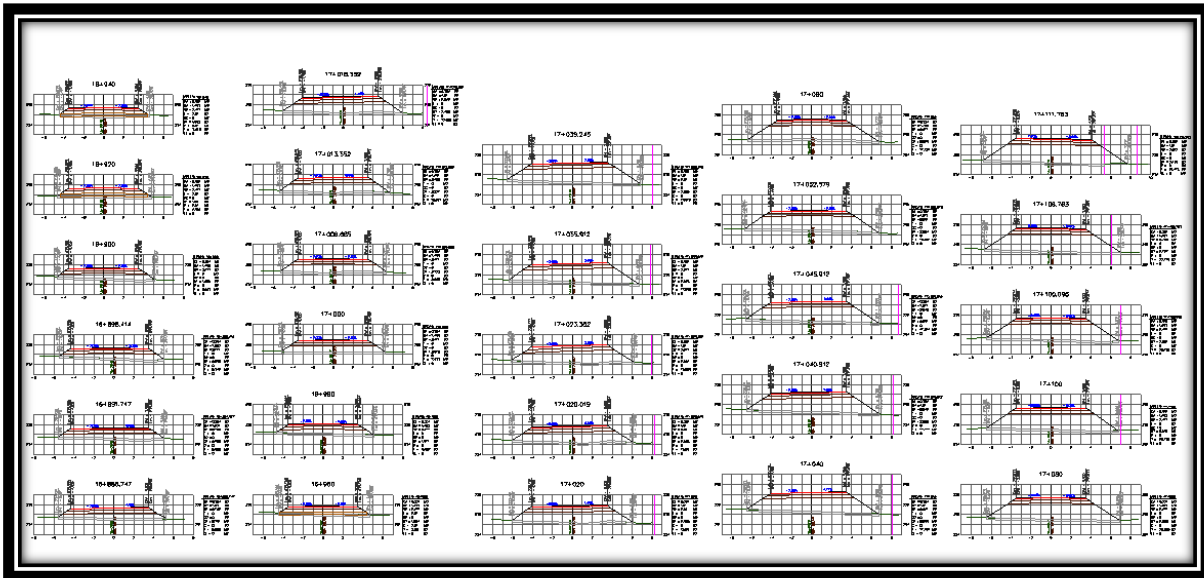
Secciones de construcción del km 16+886.747 al km 17+111.763.
